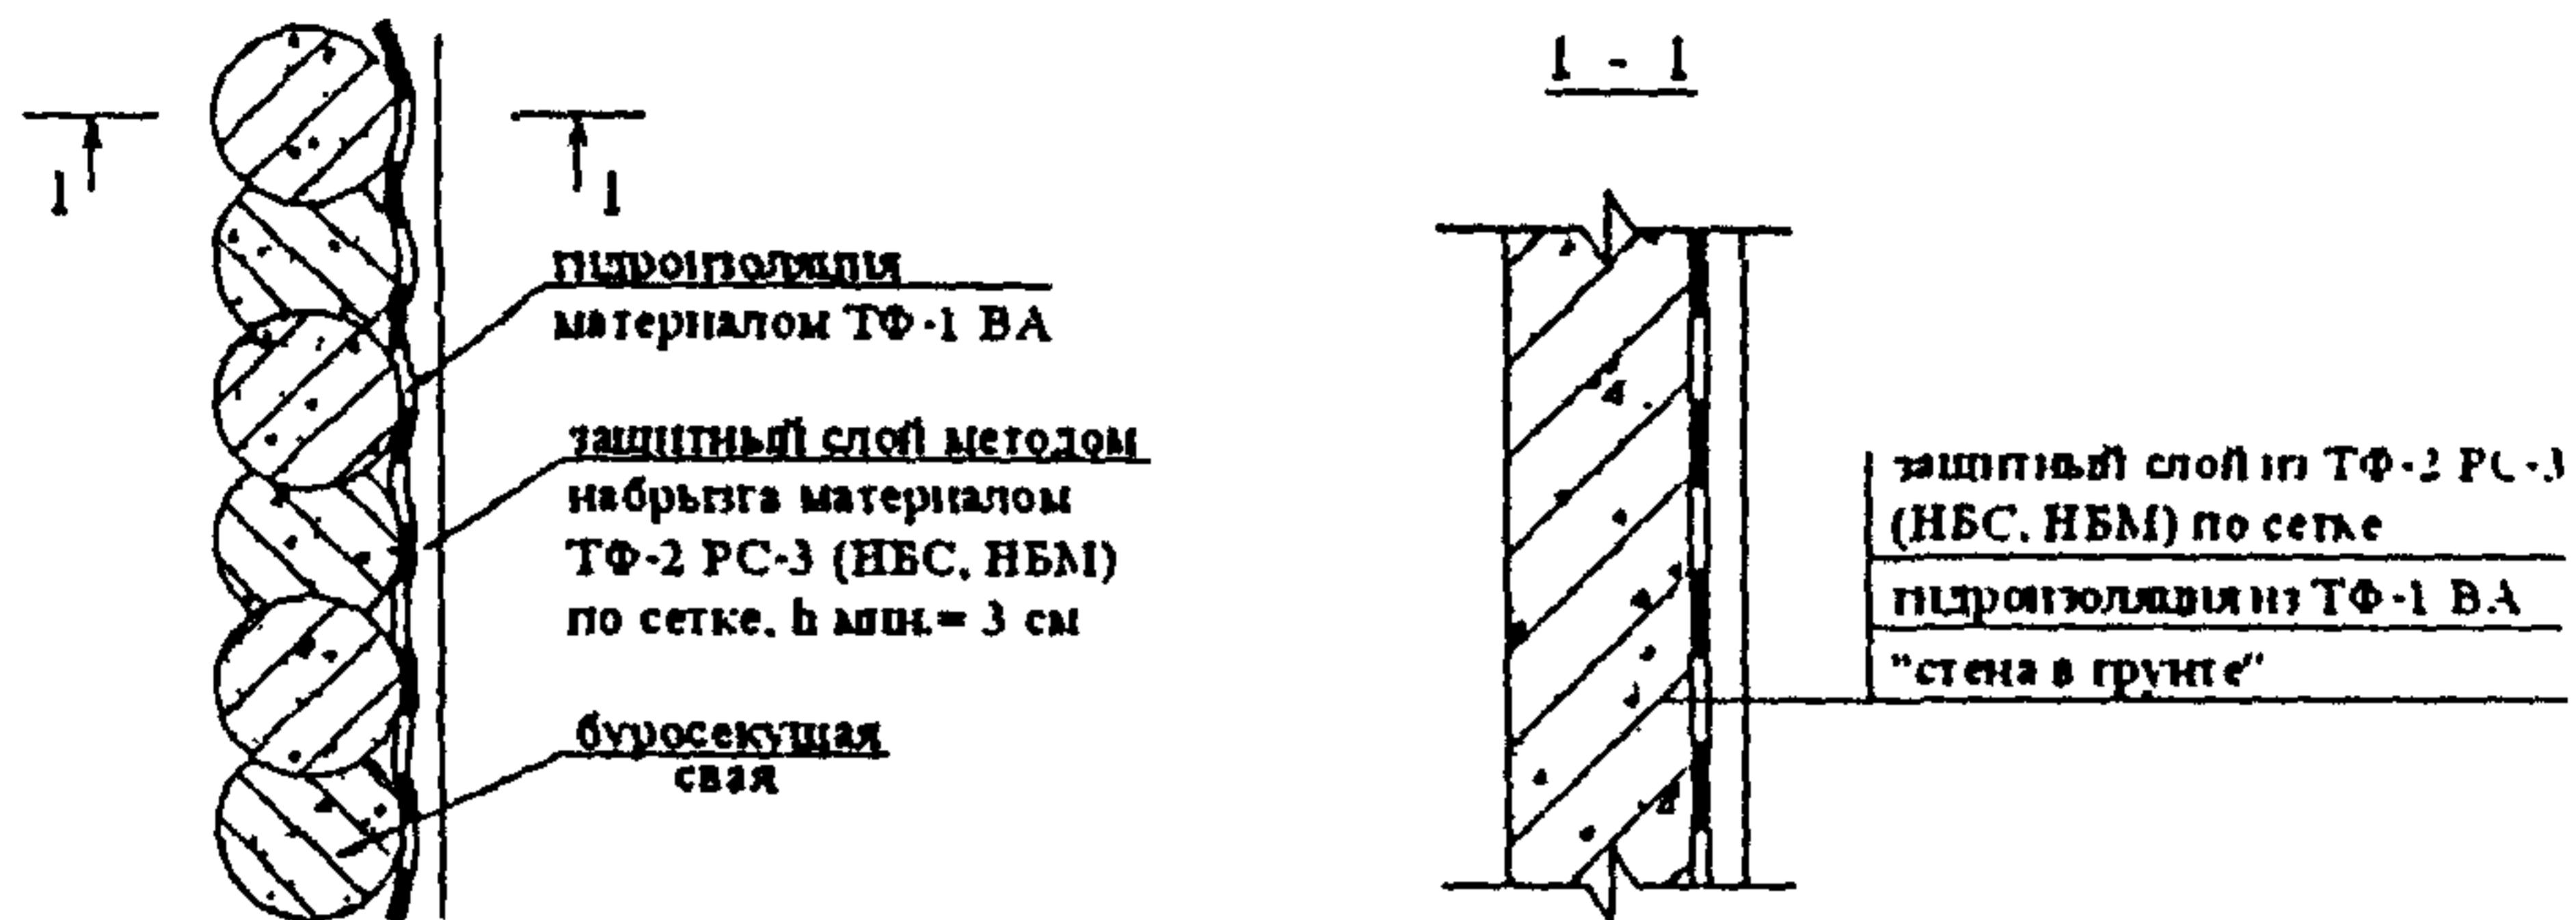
Устройство гидроизоляции и защитного слоя «стены в грунте», бurosекущие сваи
